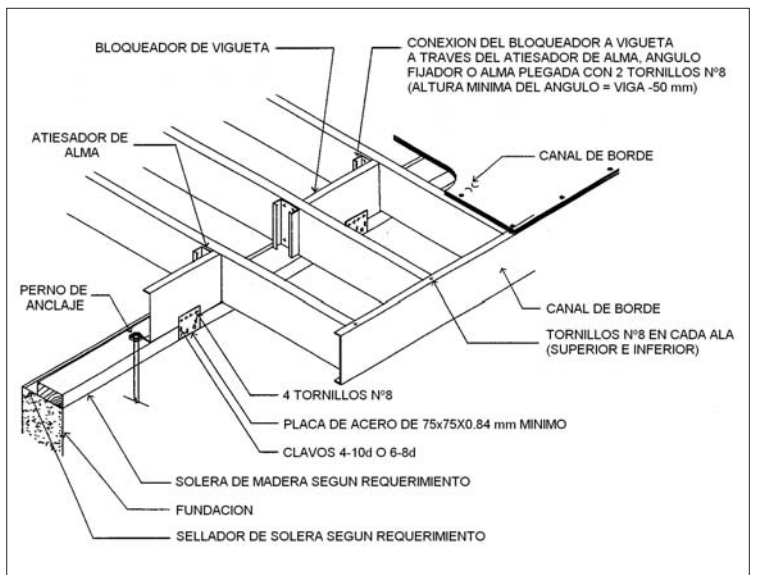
Piso en Voladizo Apoyado en Solera de Madera
